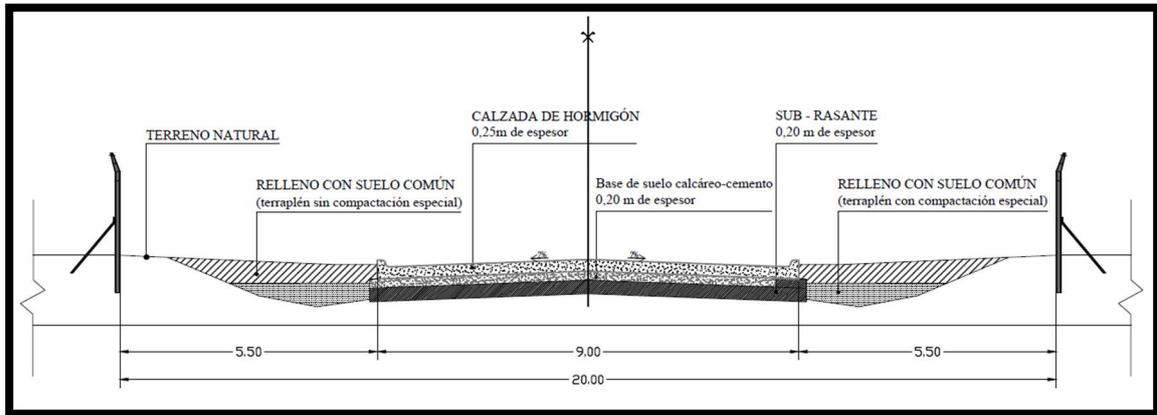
Perfil transversal de calles internas del Parque Industrial
